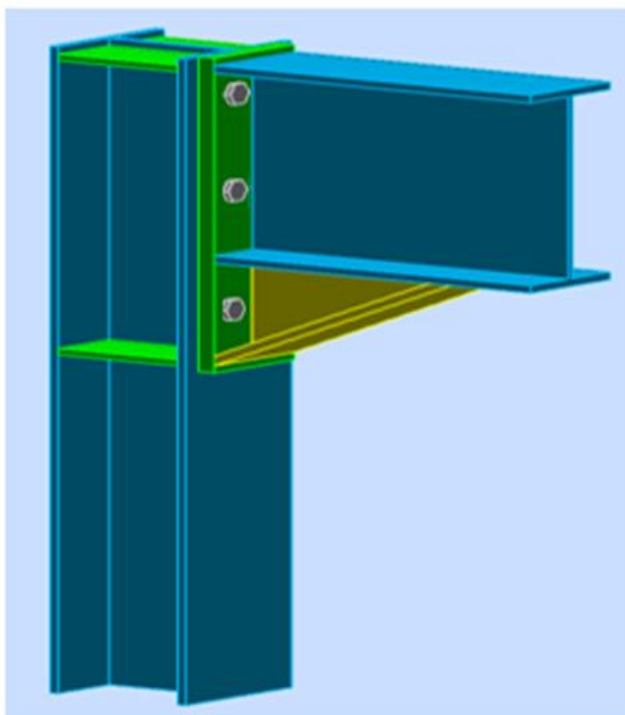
1: Assemblage poteau- poutre (encastrement).
